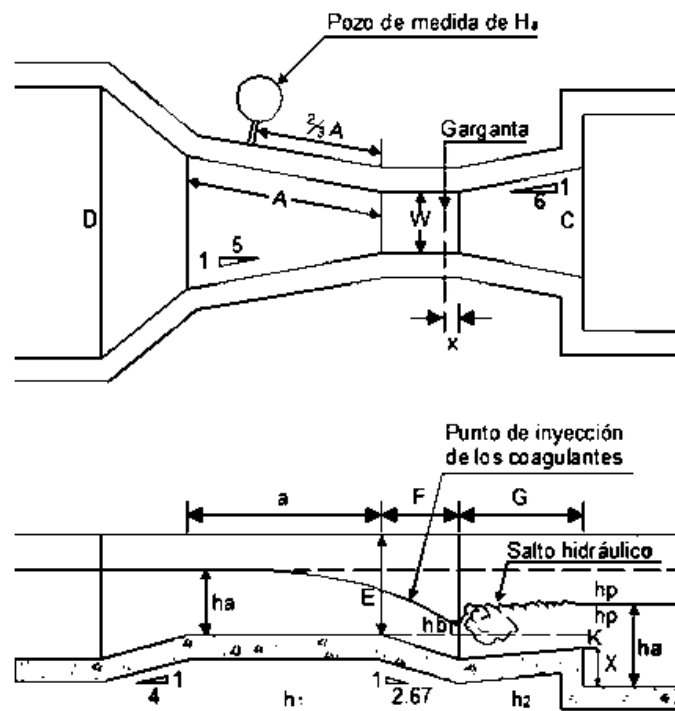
Dimensiones en planta y en corte de canaleta Parshall
